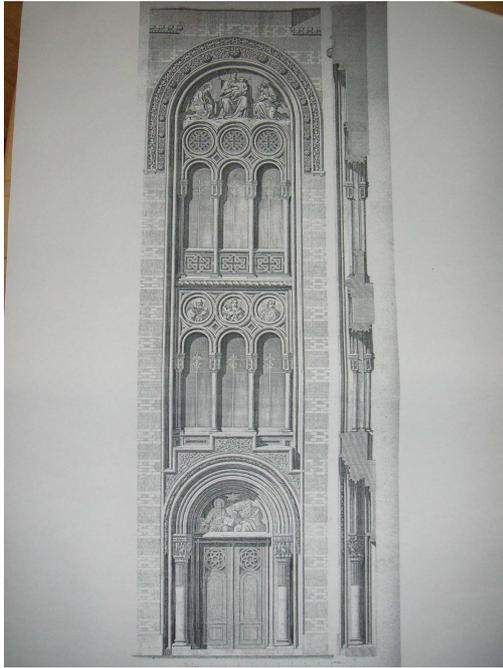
Pfarr- und Schulgebäude der nicht unirten Griechen in Wien, Detail des mittleren Teiles mit dem Haupteingang
